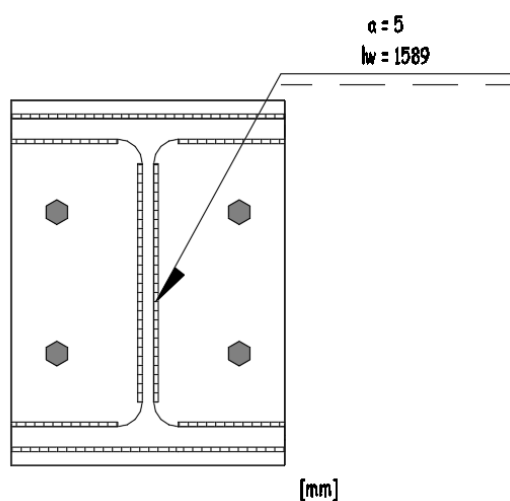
Chapa de extremo com cordão de soldadura
